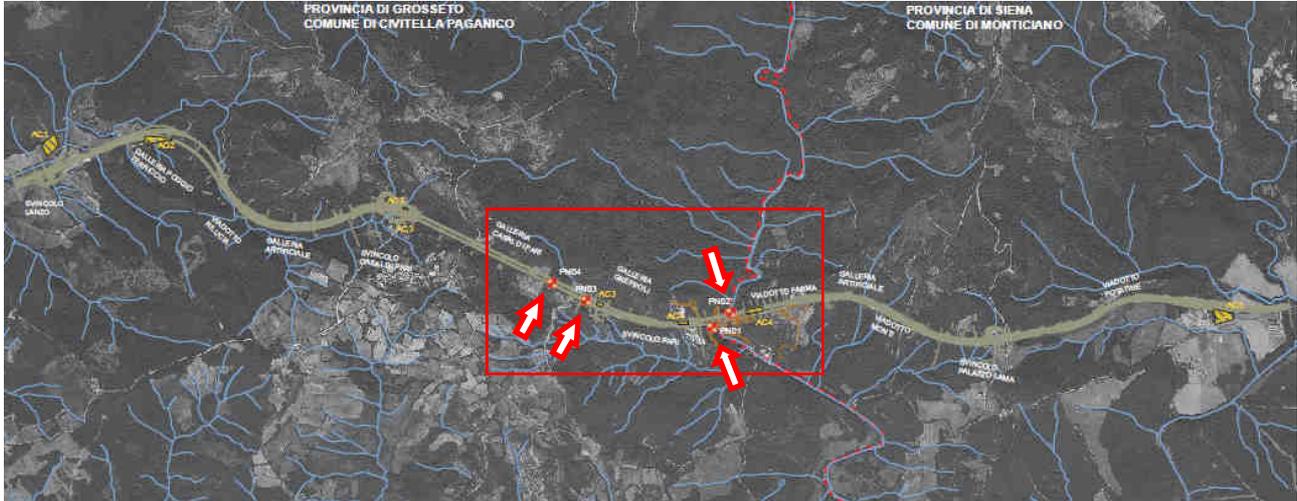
Planimetria generale – acque sotterranee / Piezometri
